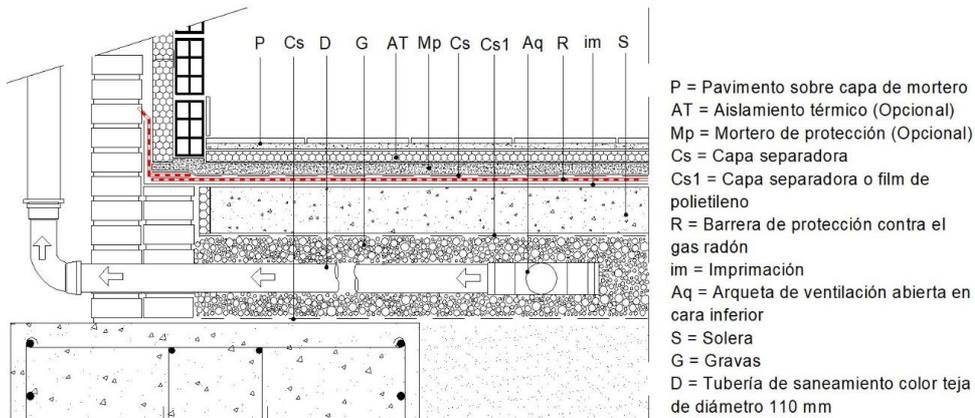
Solera y muro con barrera de protección contra el radón por el interior. Sistema monocapa adherido. Caso de rehabilitación.
